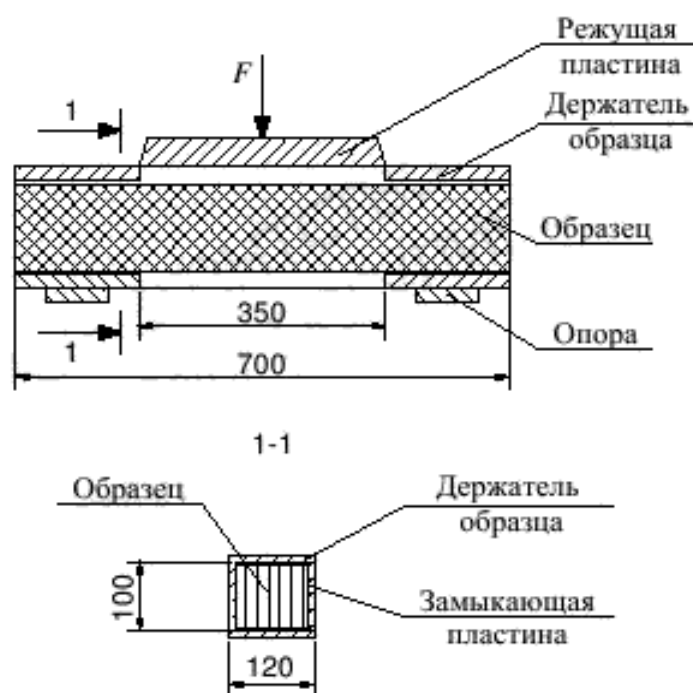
Схема устройства для определения прочности образца при испытании на сдвиг
